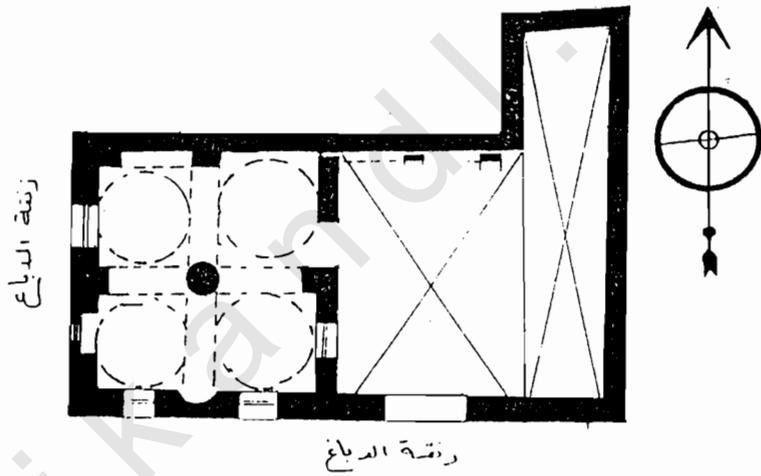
مسقط أفقي لمسجد كولوك عن أصلان آبا.
